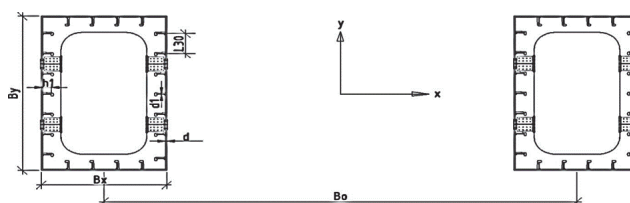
Обобщенная конструктивная схема поперечного сечения пилонов вантового моста [Figure 2. Generalized structural scheme of cross-section of cable-stayed bridge pylons]
